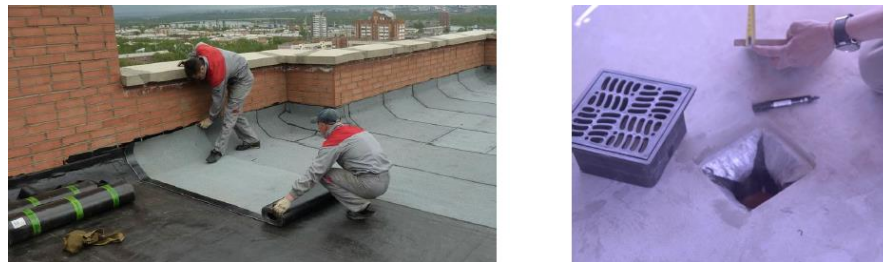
Aplicación de barrera hidrófuga. (Grupo FE, 2018)
